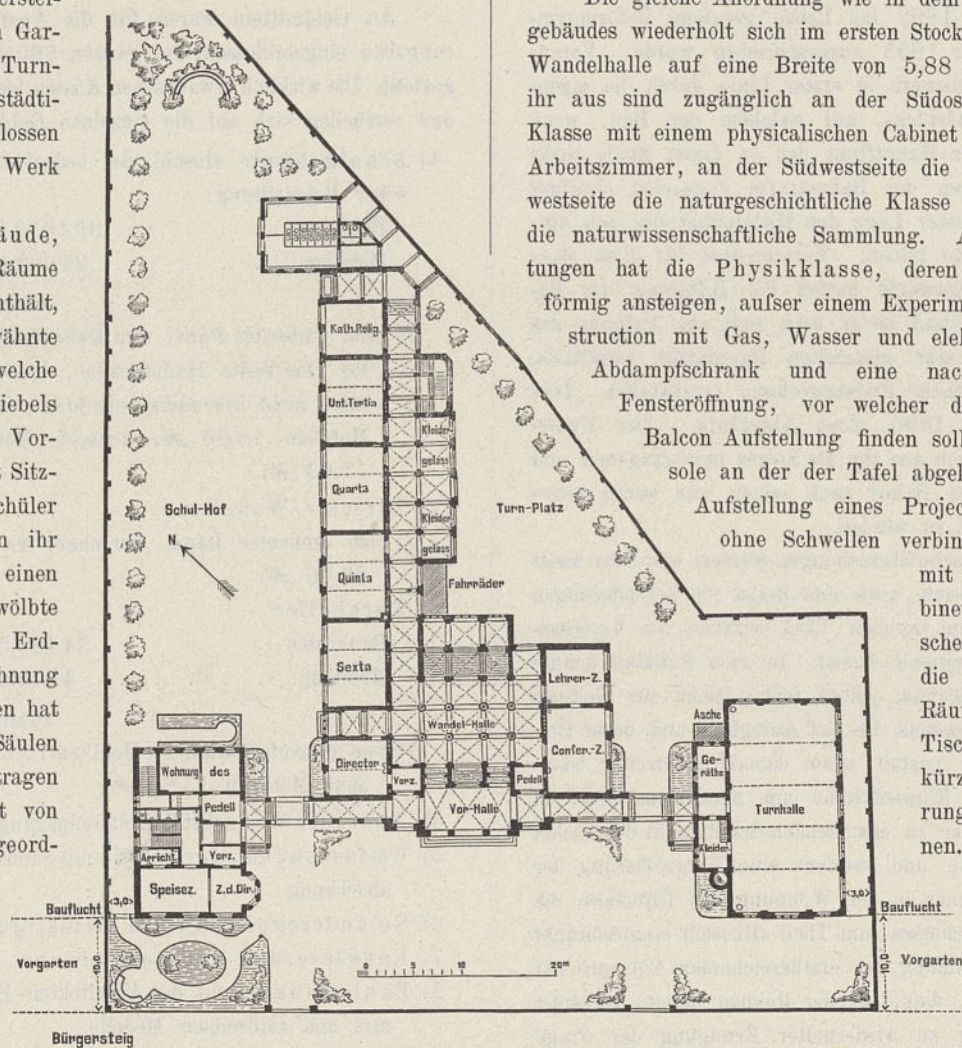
Lageplan mit Erdgeschoßgrundriß.
